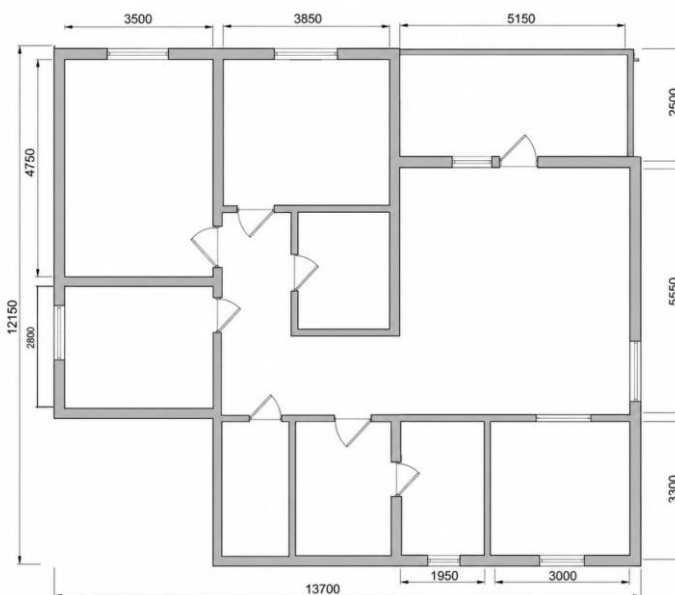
План квартири з розмірами, виконаний в Adobe Illustrator
